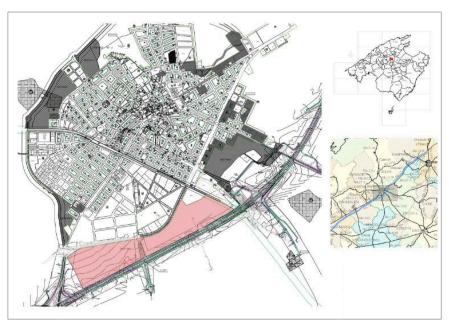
Planos de situación y emplazamiento del sector 1 (fuente: Proyecto)
